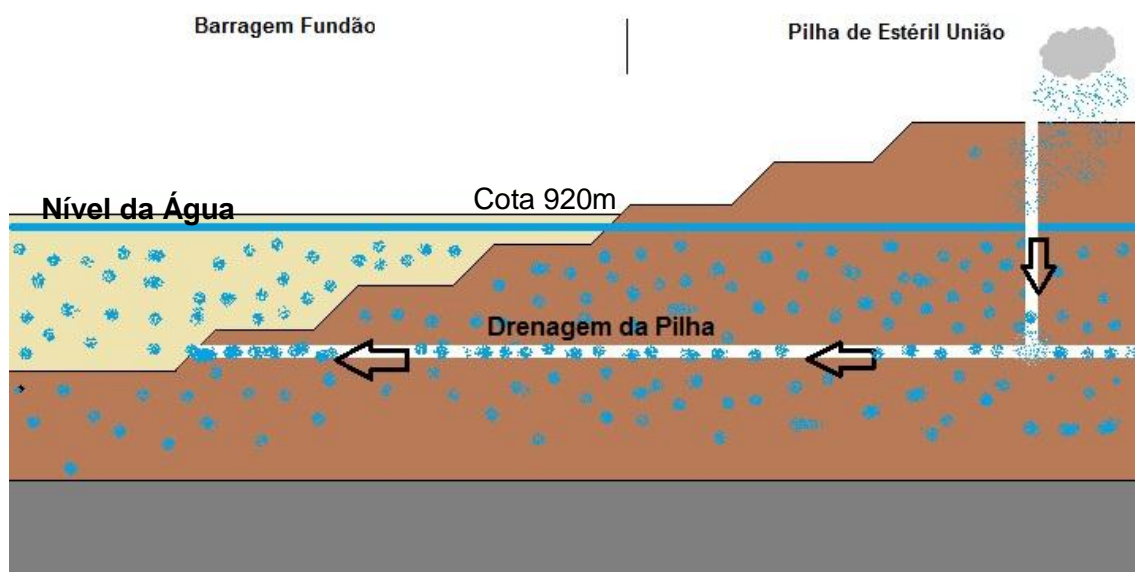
Desenho esquemático de saturação do maciço da Pilha União – estágio I.
